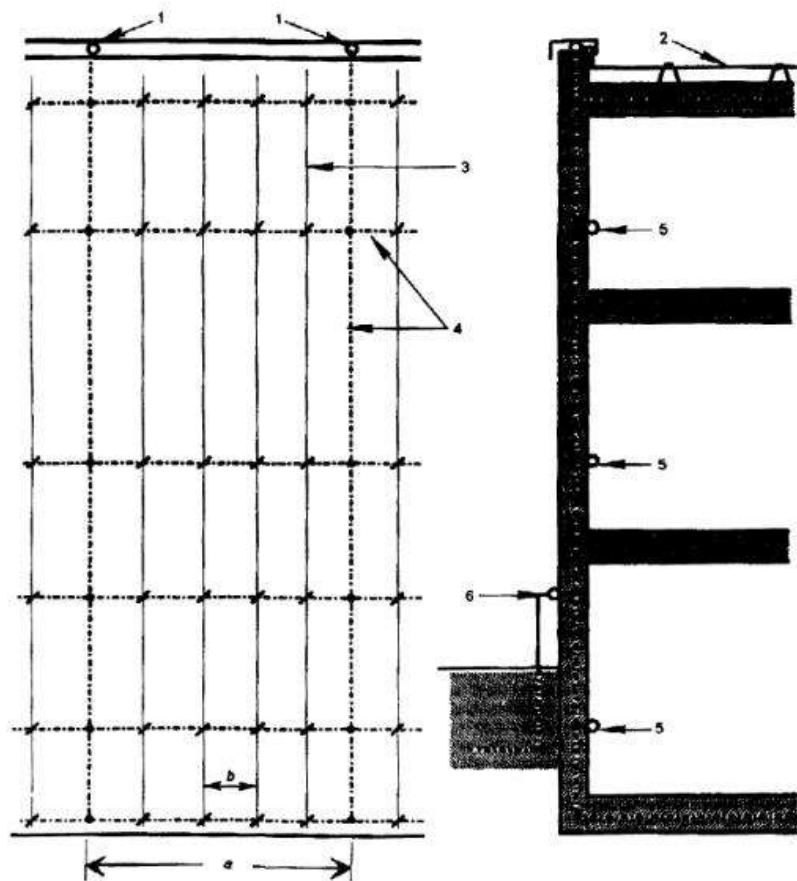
Уравнивание потенциалов в железобетонном здании, арматура стен которого используется в качестве естественного токоотвода
